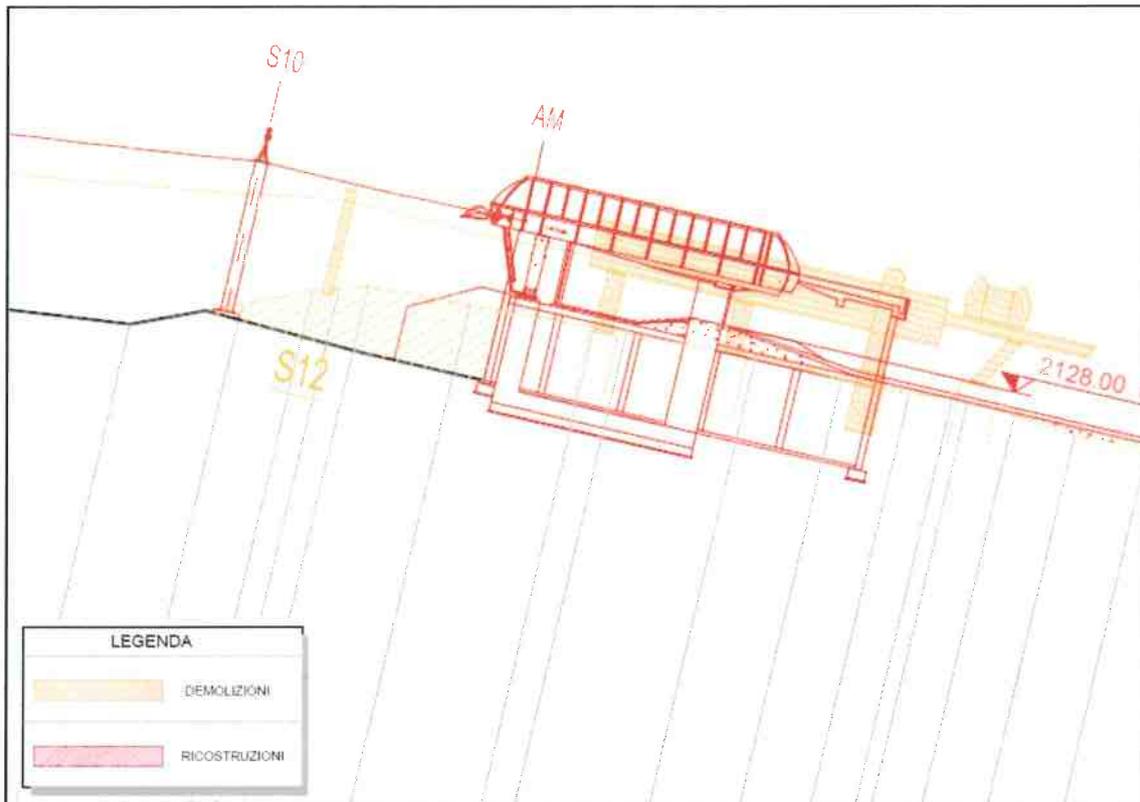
Ricostruzione e demolizione della stazione di monte, in sezione (da elaborato 6.1).
